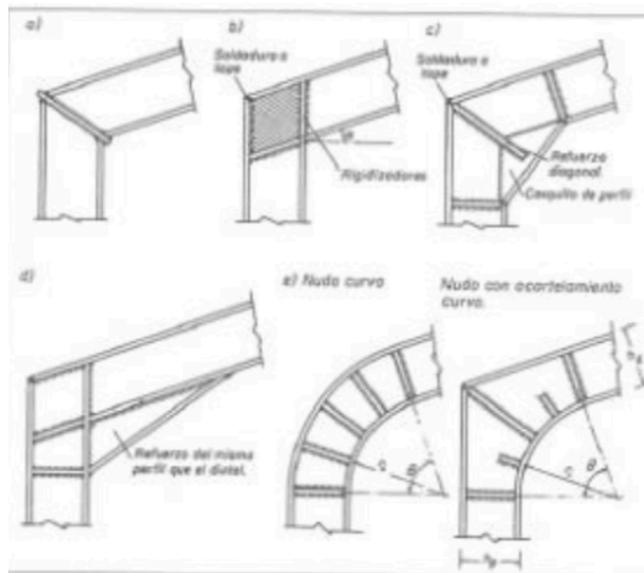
Nudos de las esquinas en estructuras industriales.
